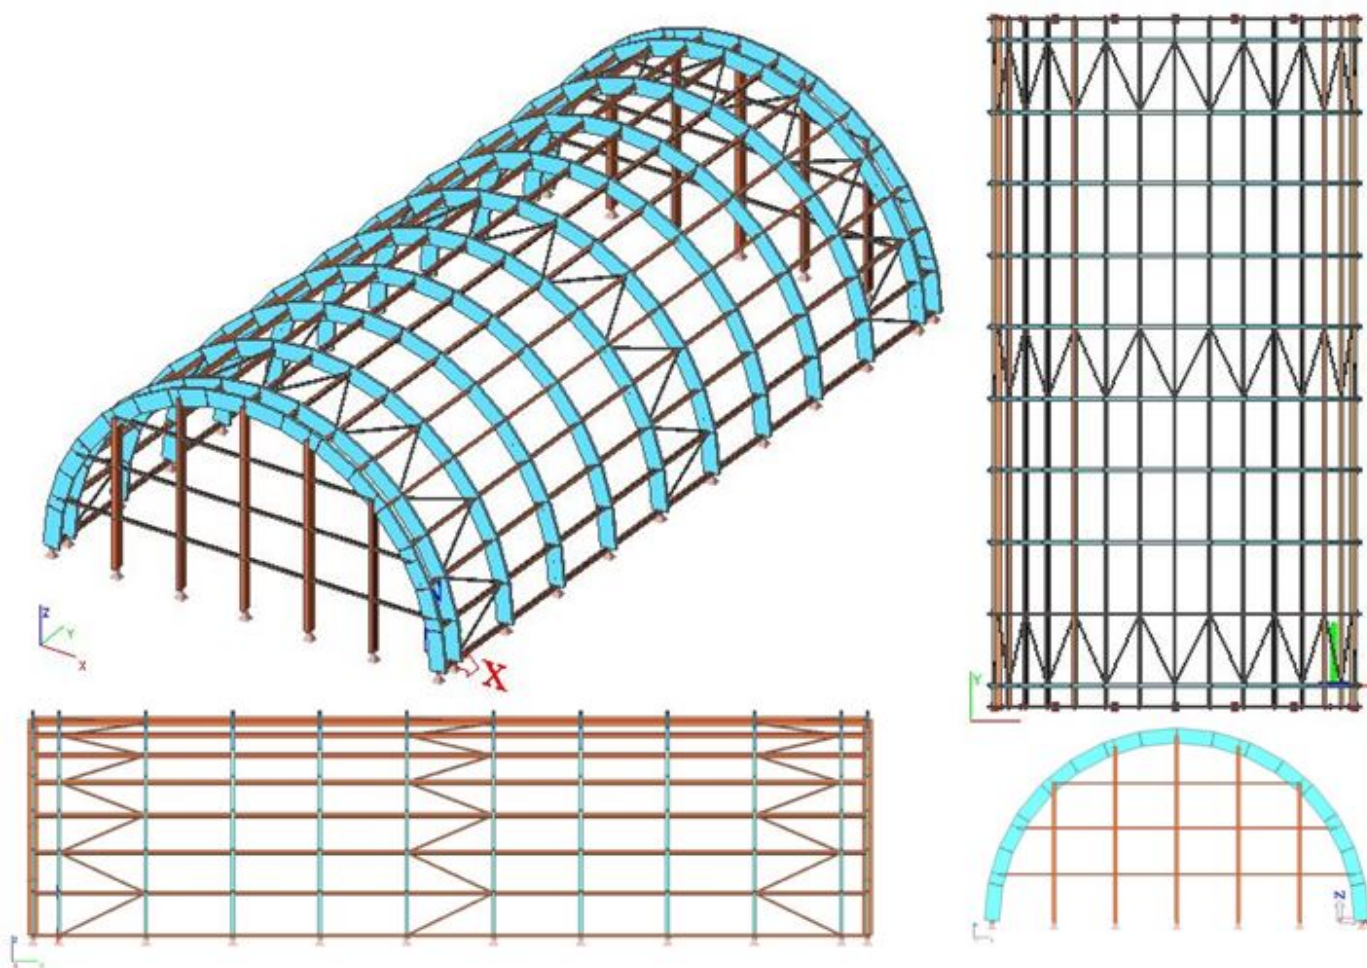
DŘEVO – PLNOSTĚNNÉ - DVOUKLOBOVÉ –GL36h (axonometrie; půdorys; boční pohled; čelní pohled)
